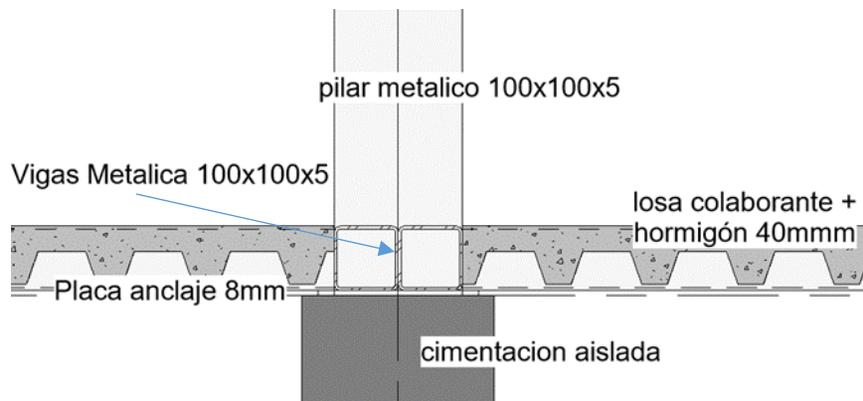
Detalle Placa anclaje de cimentación aislada soldada a módulos metálicos
